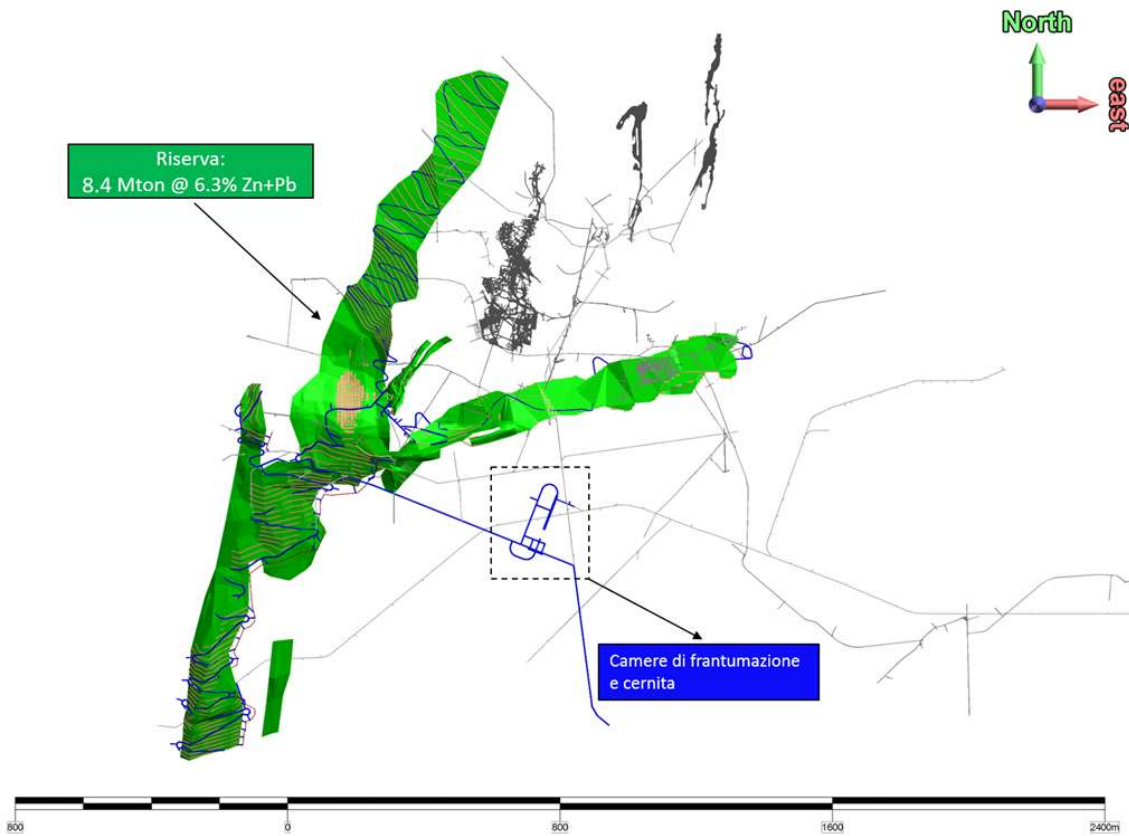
Schema del giacimento complessivo con rampe d'accesso e pertinenze
